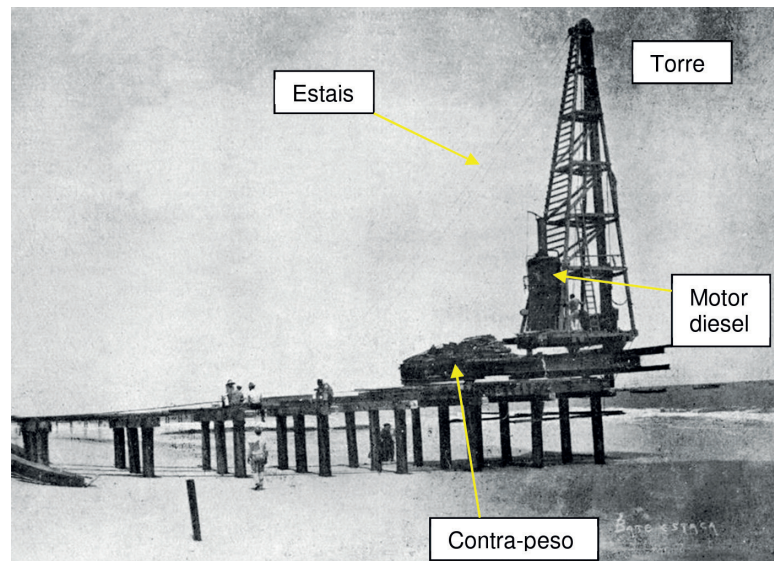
Foto da construção mostrando a torre do bate-estaca móvel tipo cantitravel.
